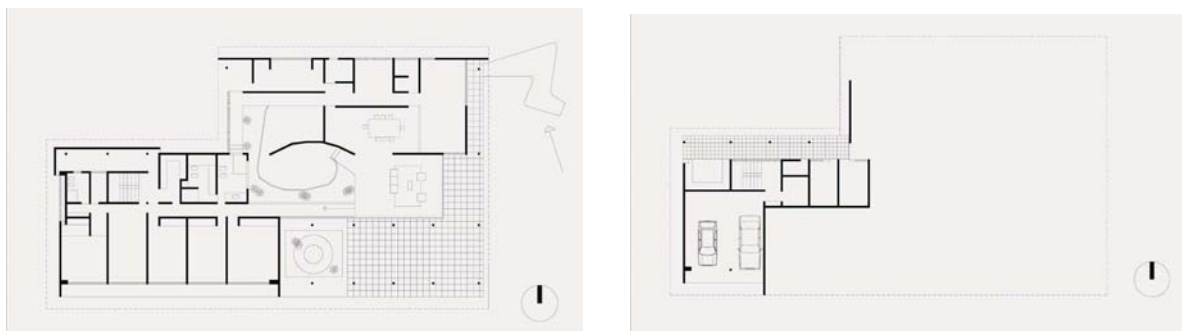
Planta baixa do pavimento superior e térreo da casa José Cordeiro Castro. 1960
